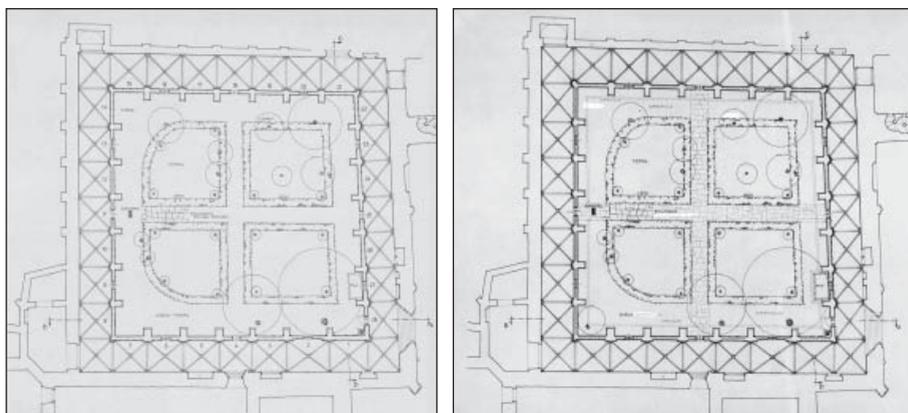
Planta del claustro antes de la restauración, izquierda y después de la restauración, derecha (Merino, 1972).
